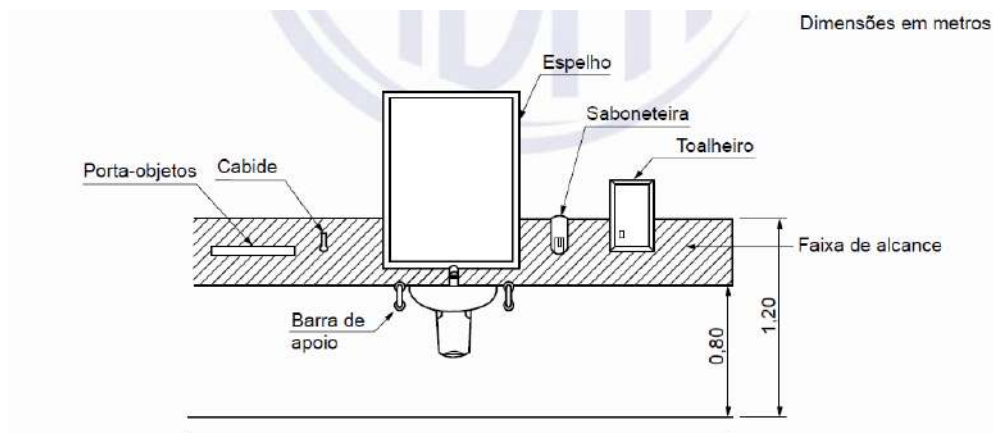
Faixa de alcance de acessórios junto ao lavatório – Vista frontal
